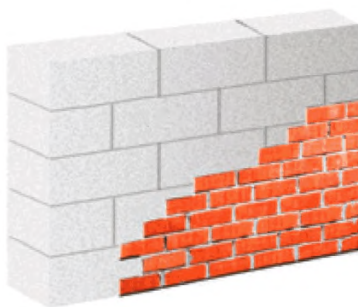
Стена из газобетонных блоков с облицовкой кирпичом
